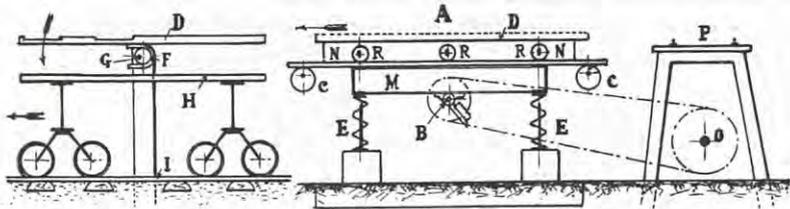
Schéma d'une table vibrante sur ressorts avec dispositif de décoffrage pour pièces planes et lourdes.
